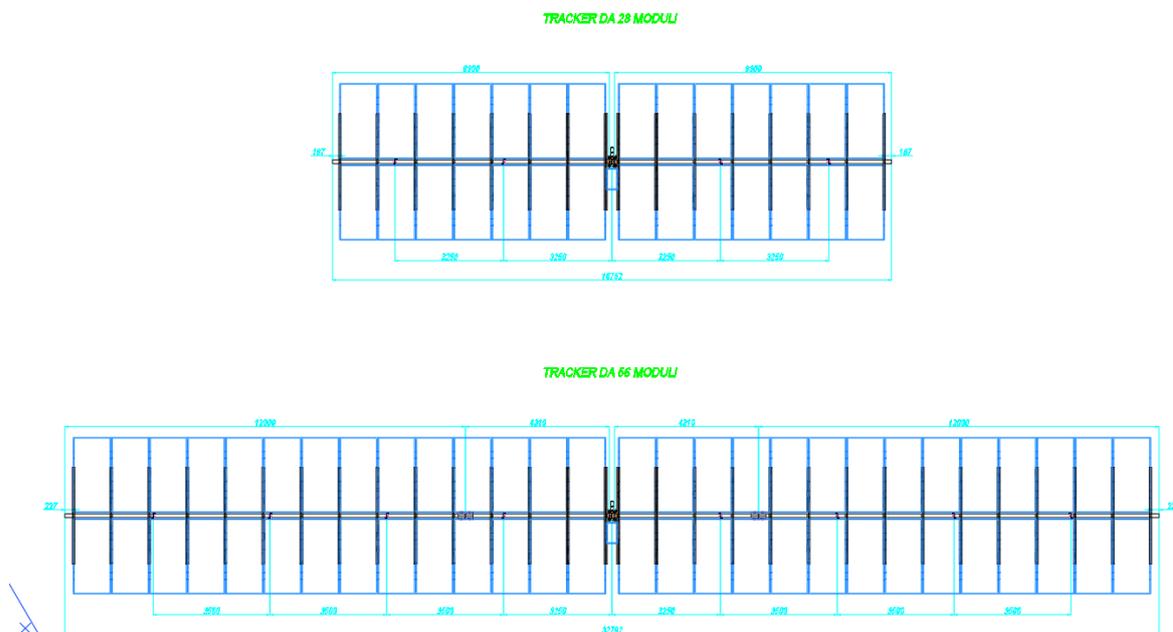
Configurazione Struttura tracker 2x28 e 2x14, vista in pianta
